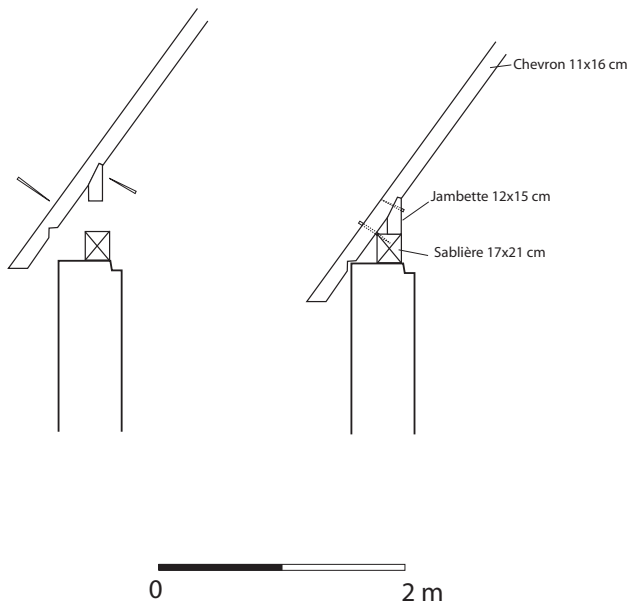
Dispositif d'assemblage de pied d'une ferme et d'un chevron à l'entretoise (1228d).
